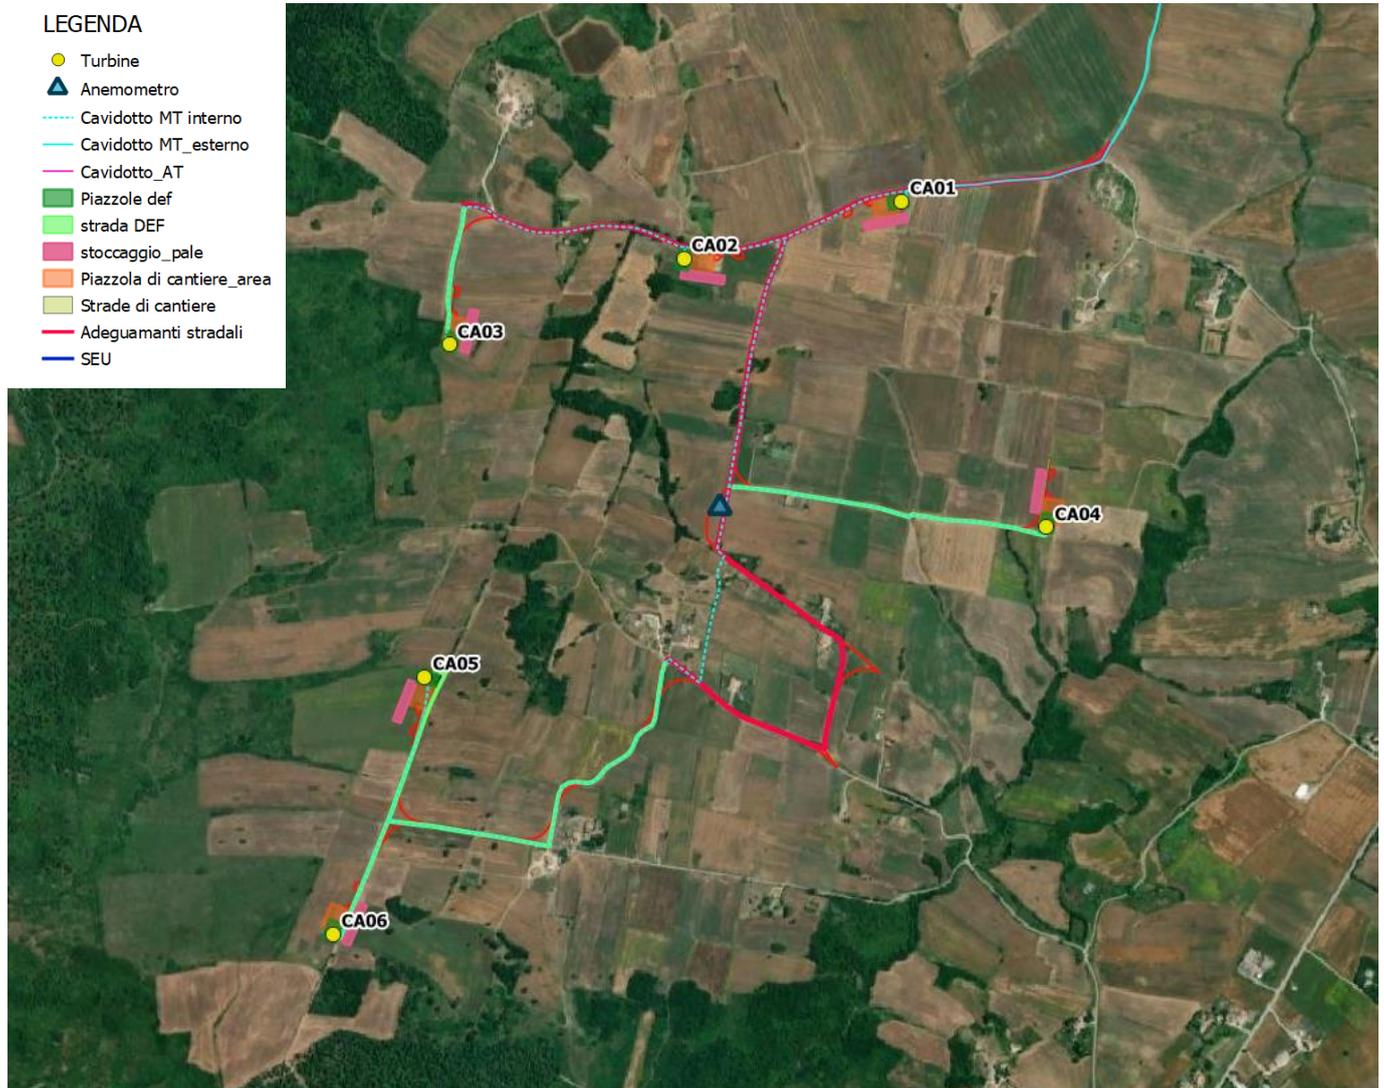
Area di sito: dettaglio layout di progetto su ortofoto
